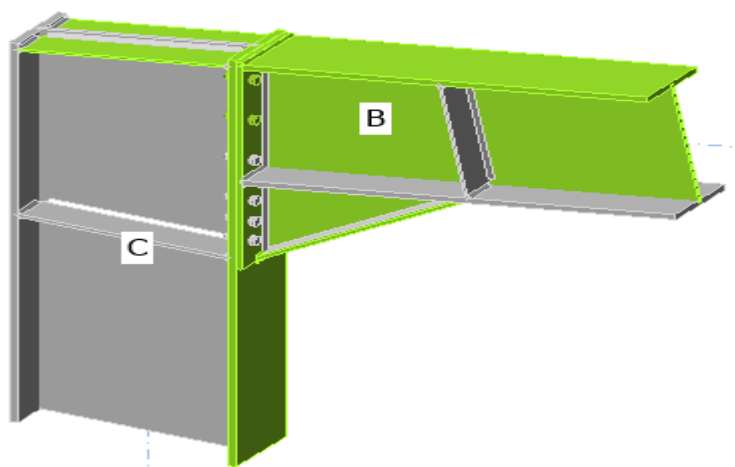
Vue d'assemblage poteau HEA800–Poutre HEA600
